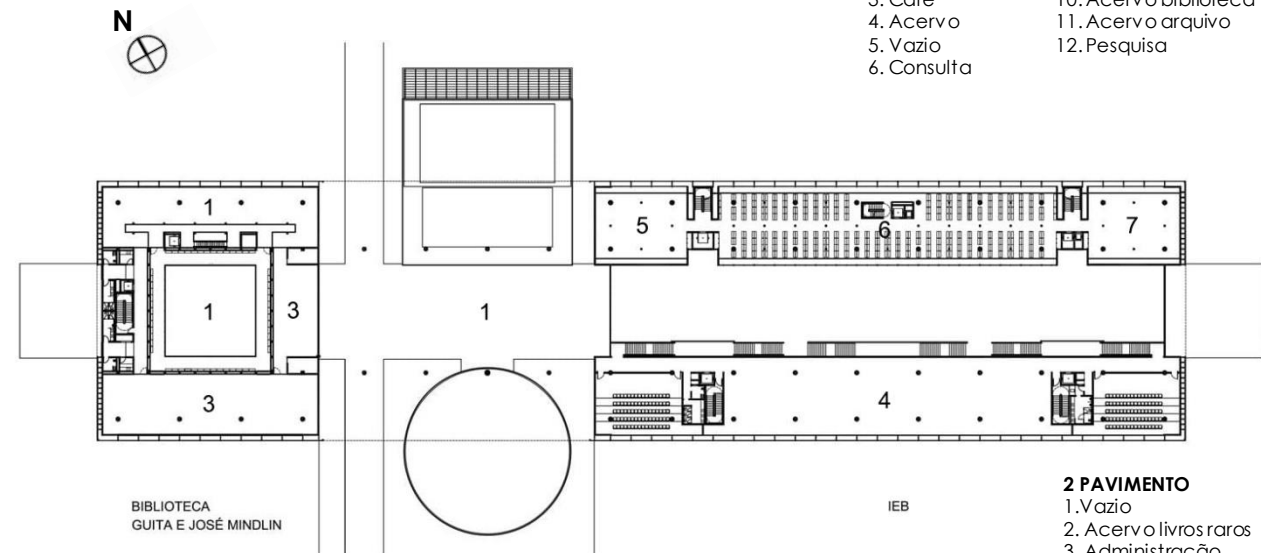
Planta baixa 2 pavimento. Fonte: Archdaily (2019c).
